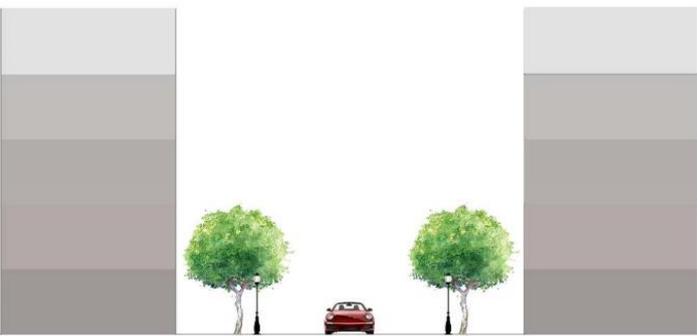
Coupe schématique sur la rue Bouda Abdelkader
